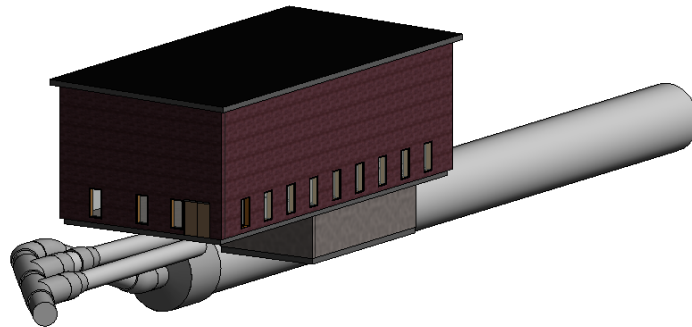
Bypasssystemet i anslutning till vattenkraftstationen.
